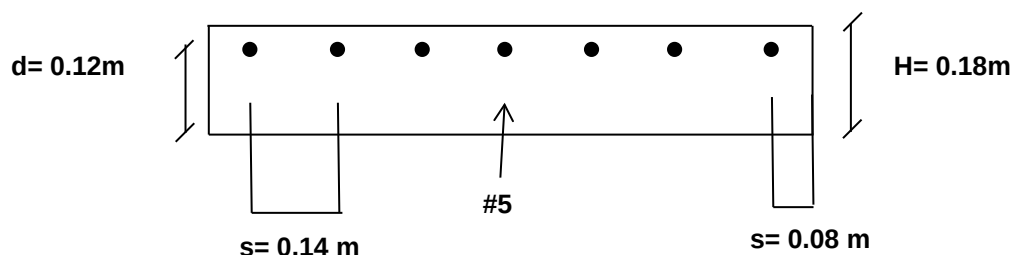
Sección longitudinal de 1 metro de la losa y su barra de refuerzo.
